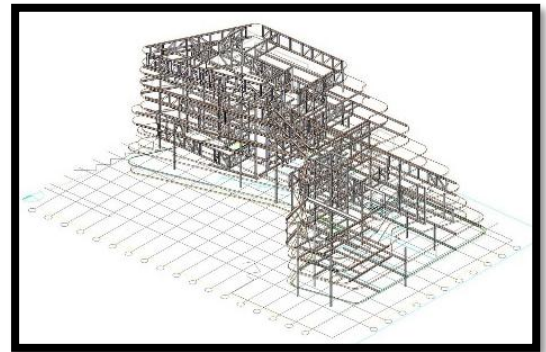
structure du bâtiment / sources ([High Park](#) — [Studio NYL](#))
